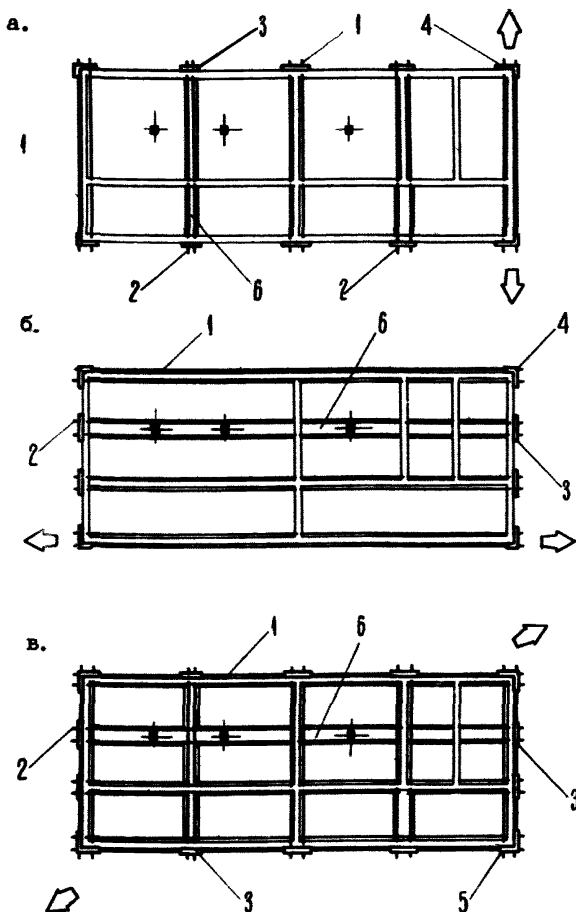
Схемы усиления докольных (фундаментных) поясов здания и устройства железобетонных связей-распорок между стенами с большим свободным пролетом:
